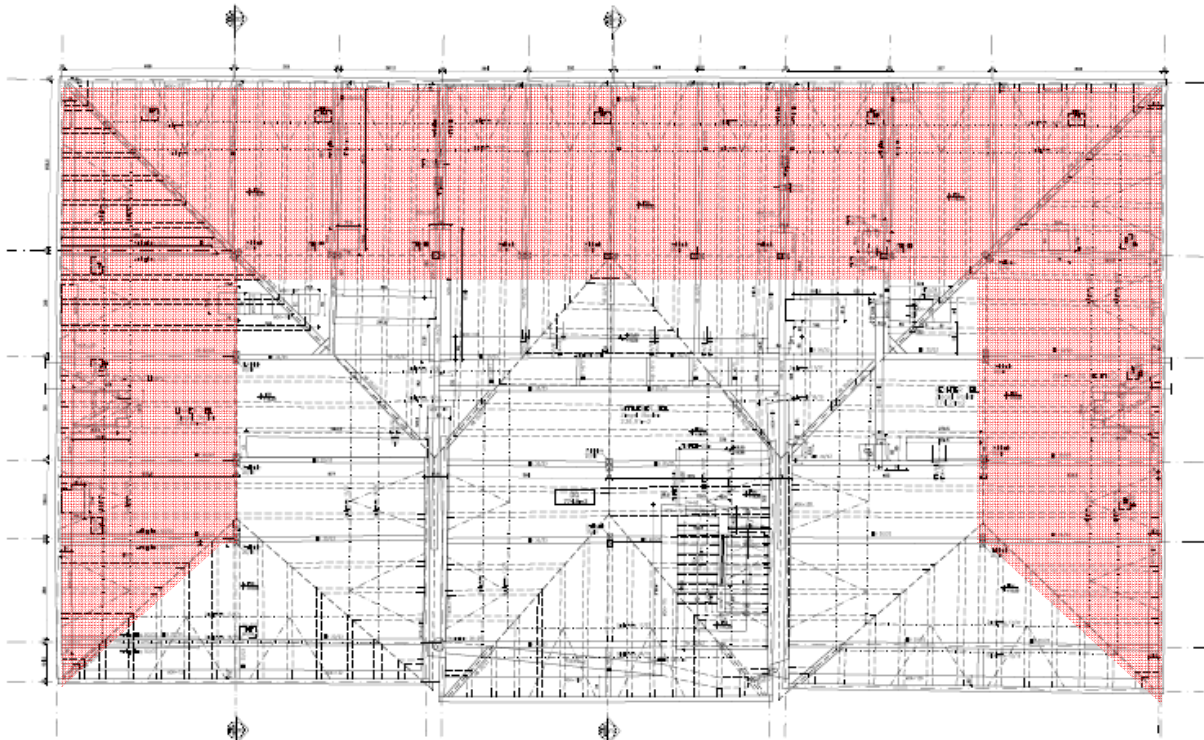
Schema-Grundriss des Barocken Dachstuhls über dem Mittelresalits des Haupttraktes. Die Dachflächen mit historischer Ziegeldeckung sind rot markiert (Quelle: MuseumsQuartier Wien)
